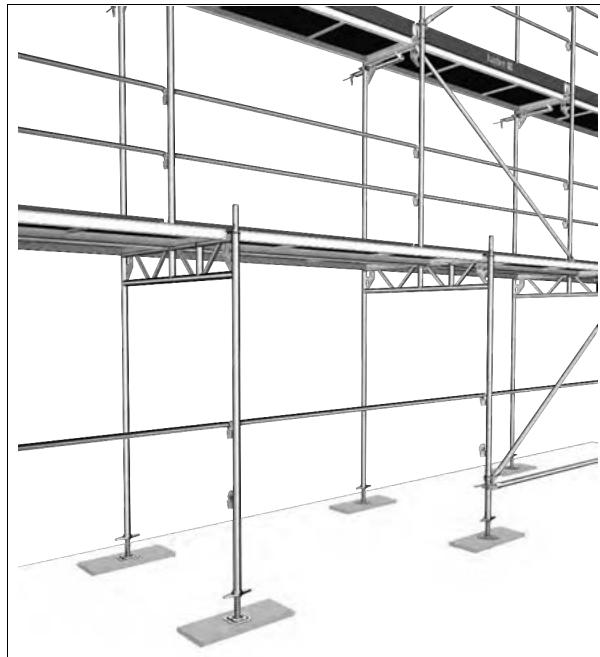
Unterste Lage mit Durchgangsrahmen, Grundkonfiguration
